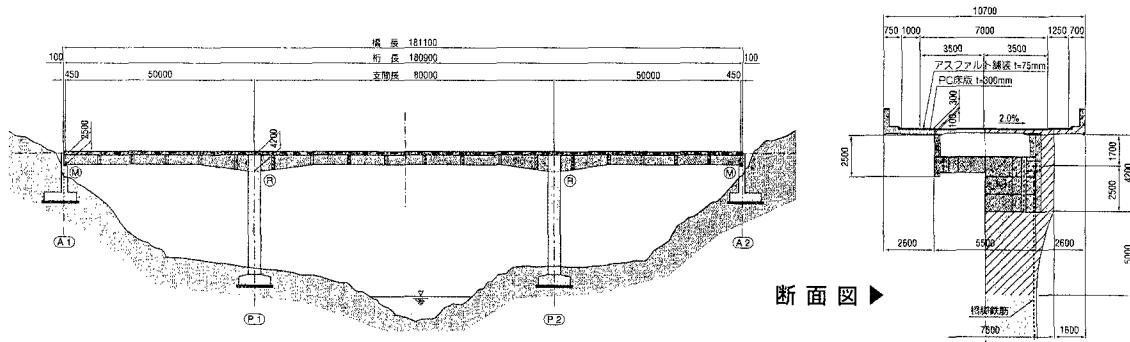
提案する鋼・コンクリート複合ラーメン橋の構造
